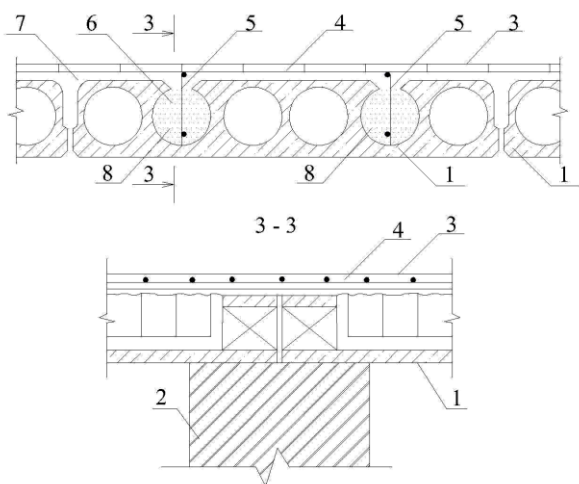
Нарощування плит зверху при недостатньому зчепленні поверхонь: 1 – підсилювана плита; 2 – опора (блок або балка); 3 – монолітний шар бетону; 4 – арматурна сітка; 5 – арматурні каркаси; 6 – вирубані полиці плит для встановлення каркасів; 7 – поверхні зчеплення монолітного бетону з плитами; 8 – бетон замоноличення вирубаних полиць і порожнеч
